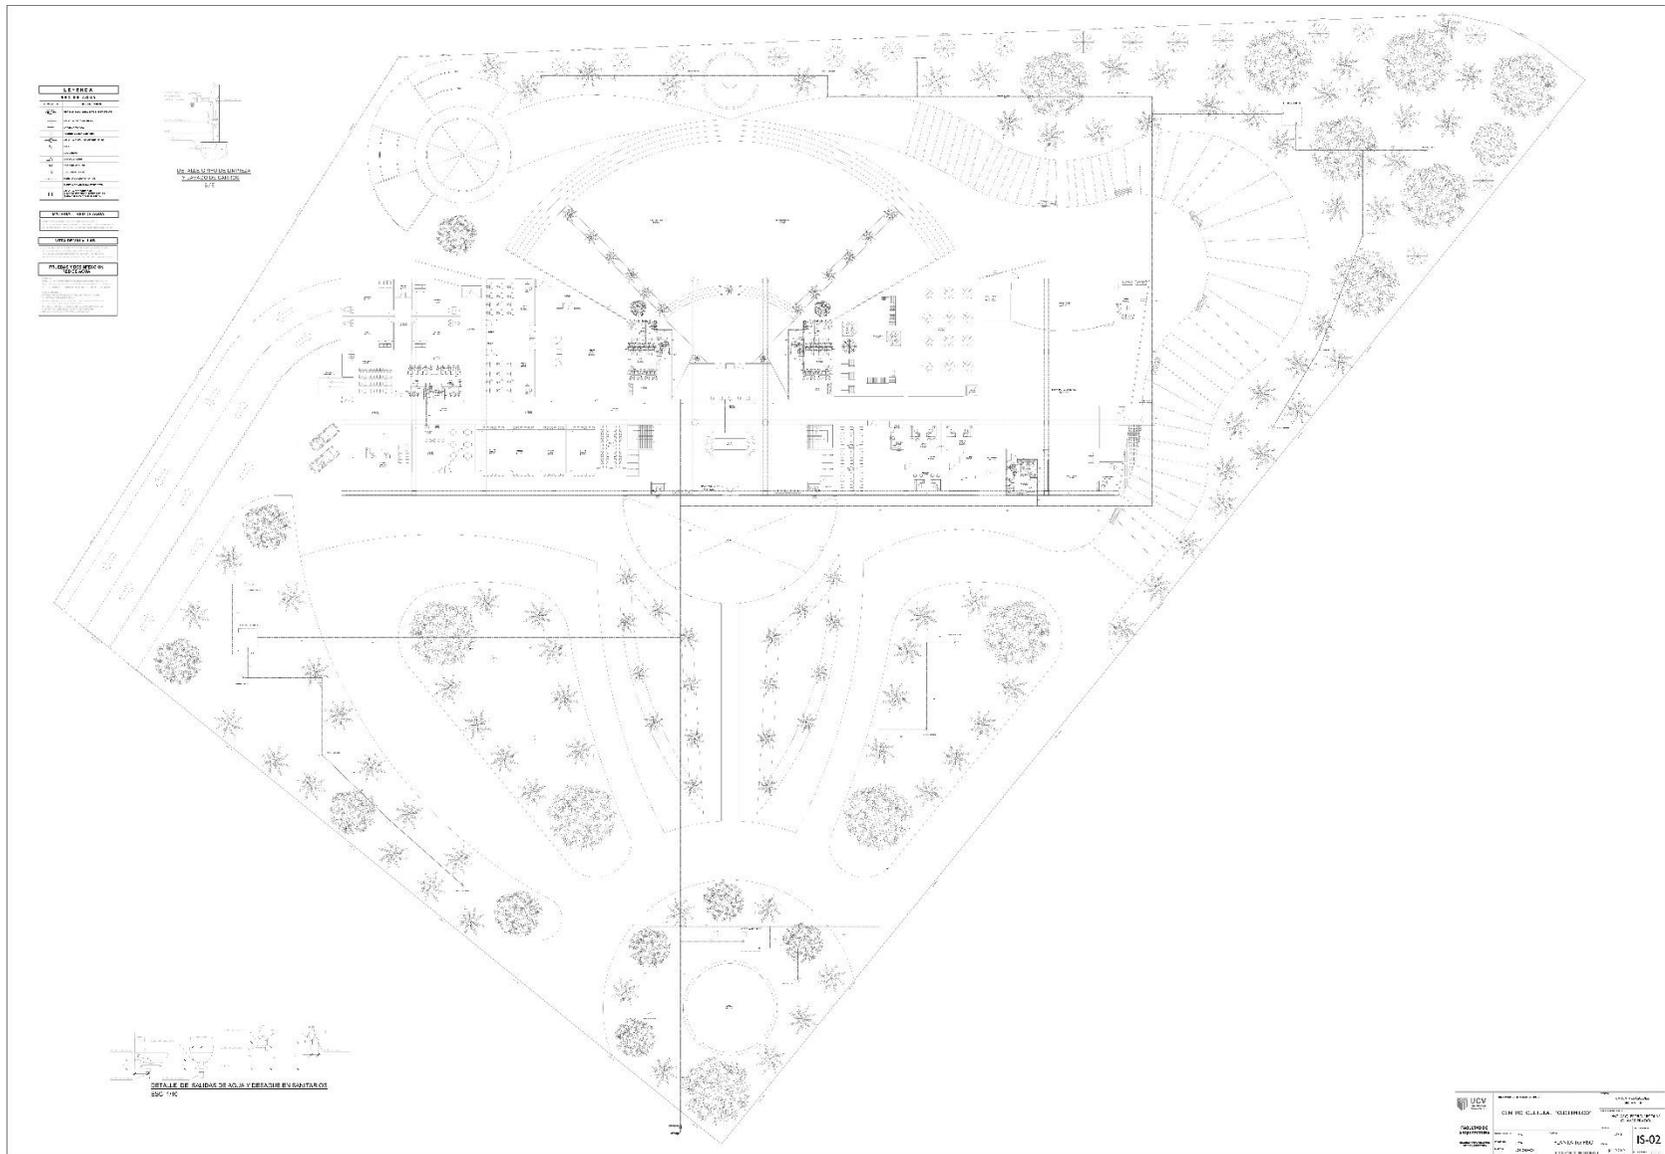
Plano de Agua Planta 1er Piso. Elaboración propia
